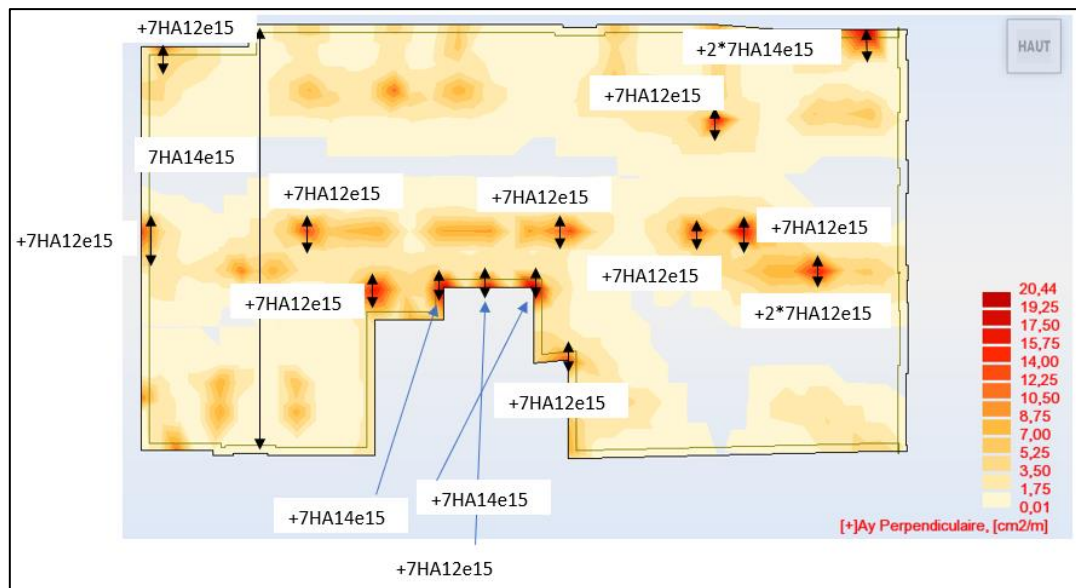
Schéma de ferrailage du plancher haut 1er étage (lit supérieur d'armatures Ay(+))
